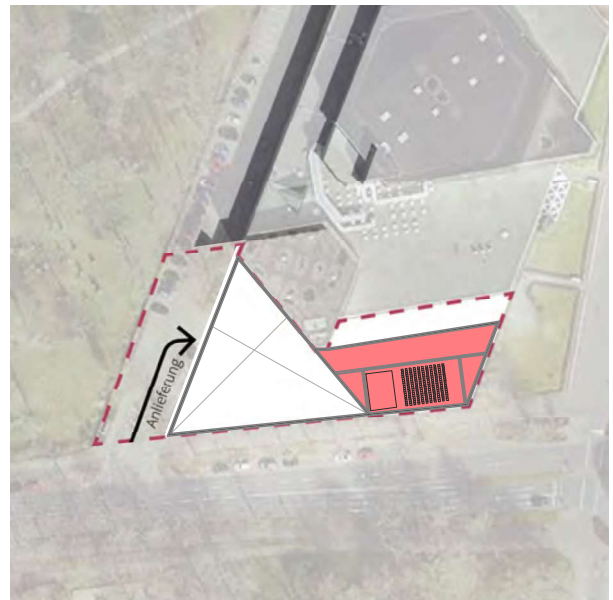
Grundriss OG3 Stadthalle V1
